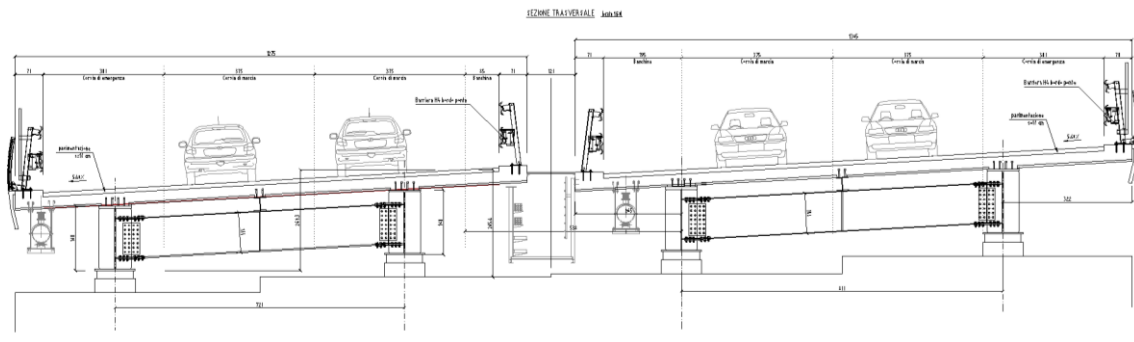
Attraversamento Canale ENEL: sezione trasversale
